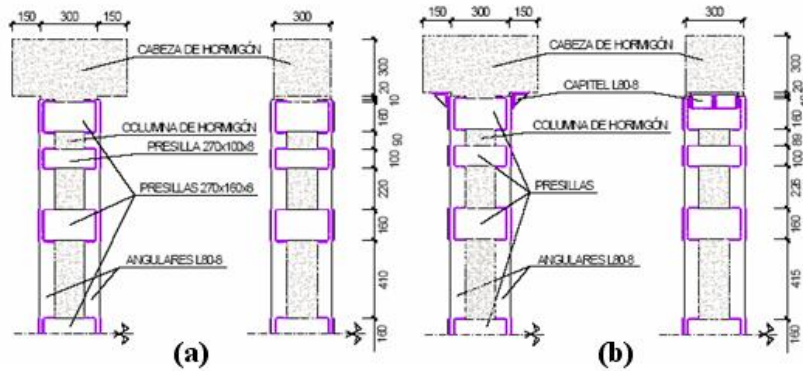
Refuerzo de los soportes ensayados a compresión centrada con 7 presillas: a) probetas PAC y PAD; b) probetas PBC y PBD (adaptada de Adam, 2007)
